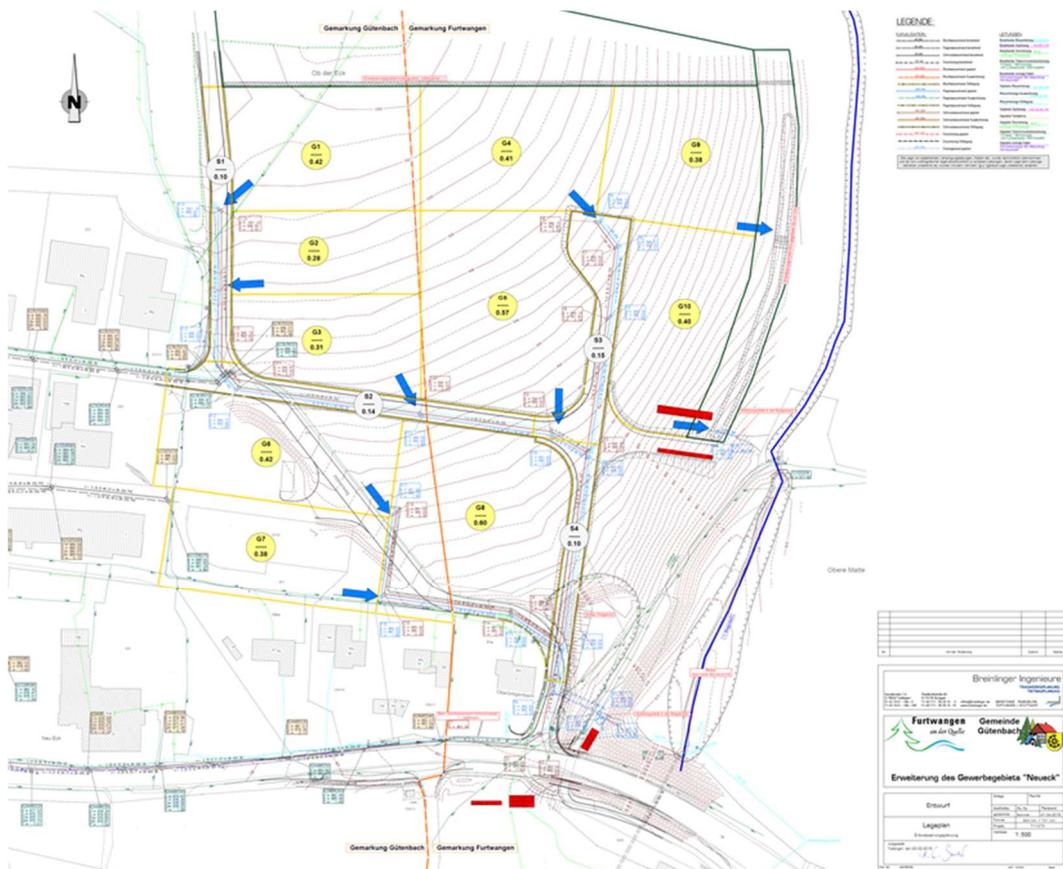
Straßenplanung/ Erschließungsplanung Schmutzwasser, IB Breinlinger, Planstand 26.04.2016
